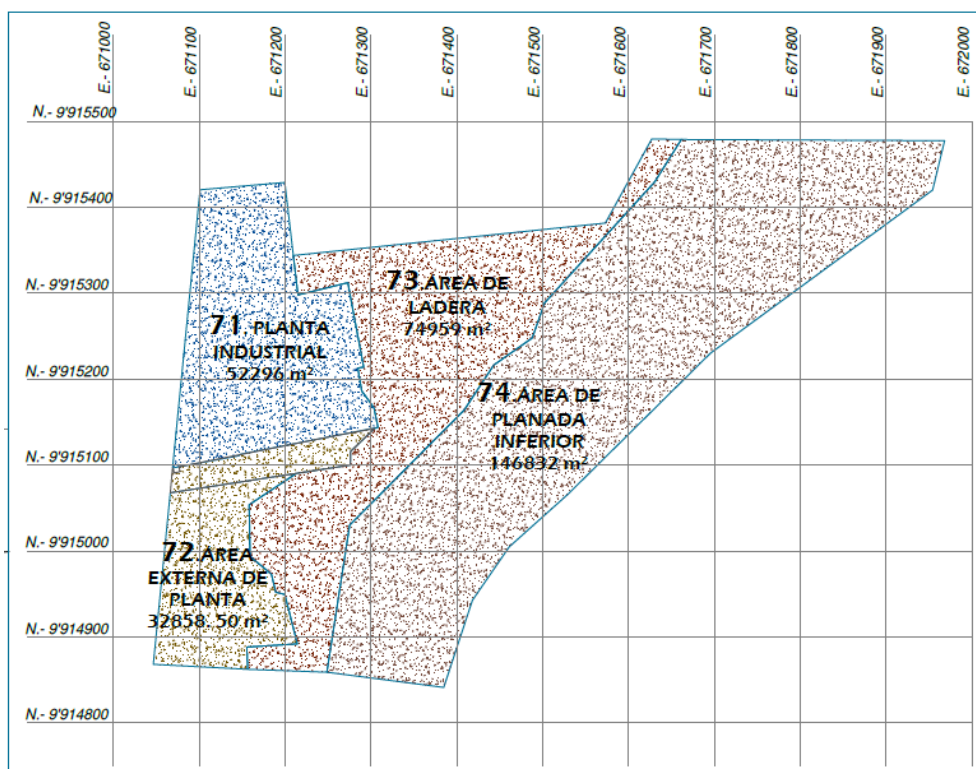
Plano de Implantación Planta Pronaca Quevedo
